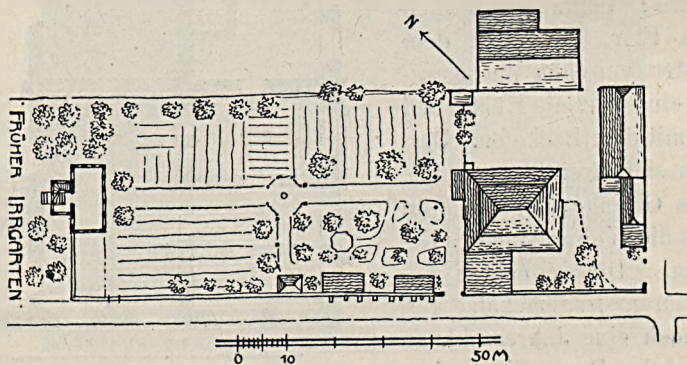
Eckartsberger Schlößchen, Lageplan.
